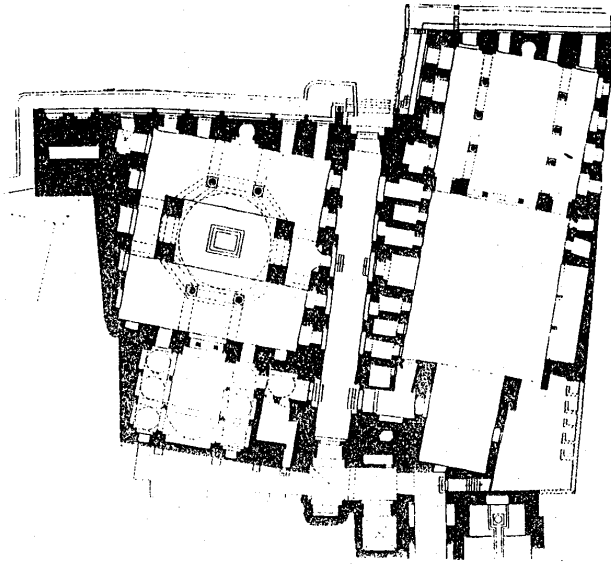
مسقط أفقي لمدرسة تتر الحجازية بالقاهرة (عن : أحمد عبد الرازق) .
